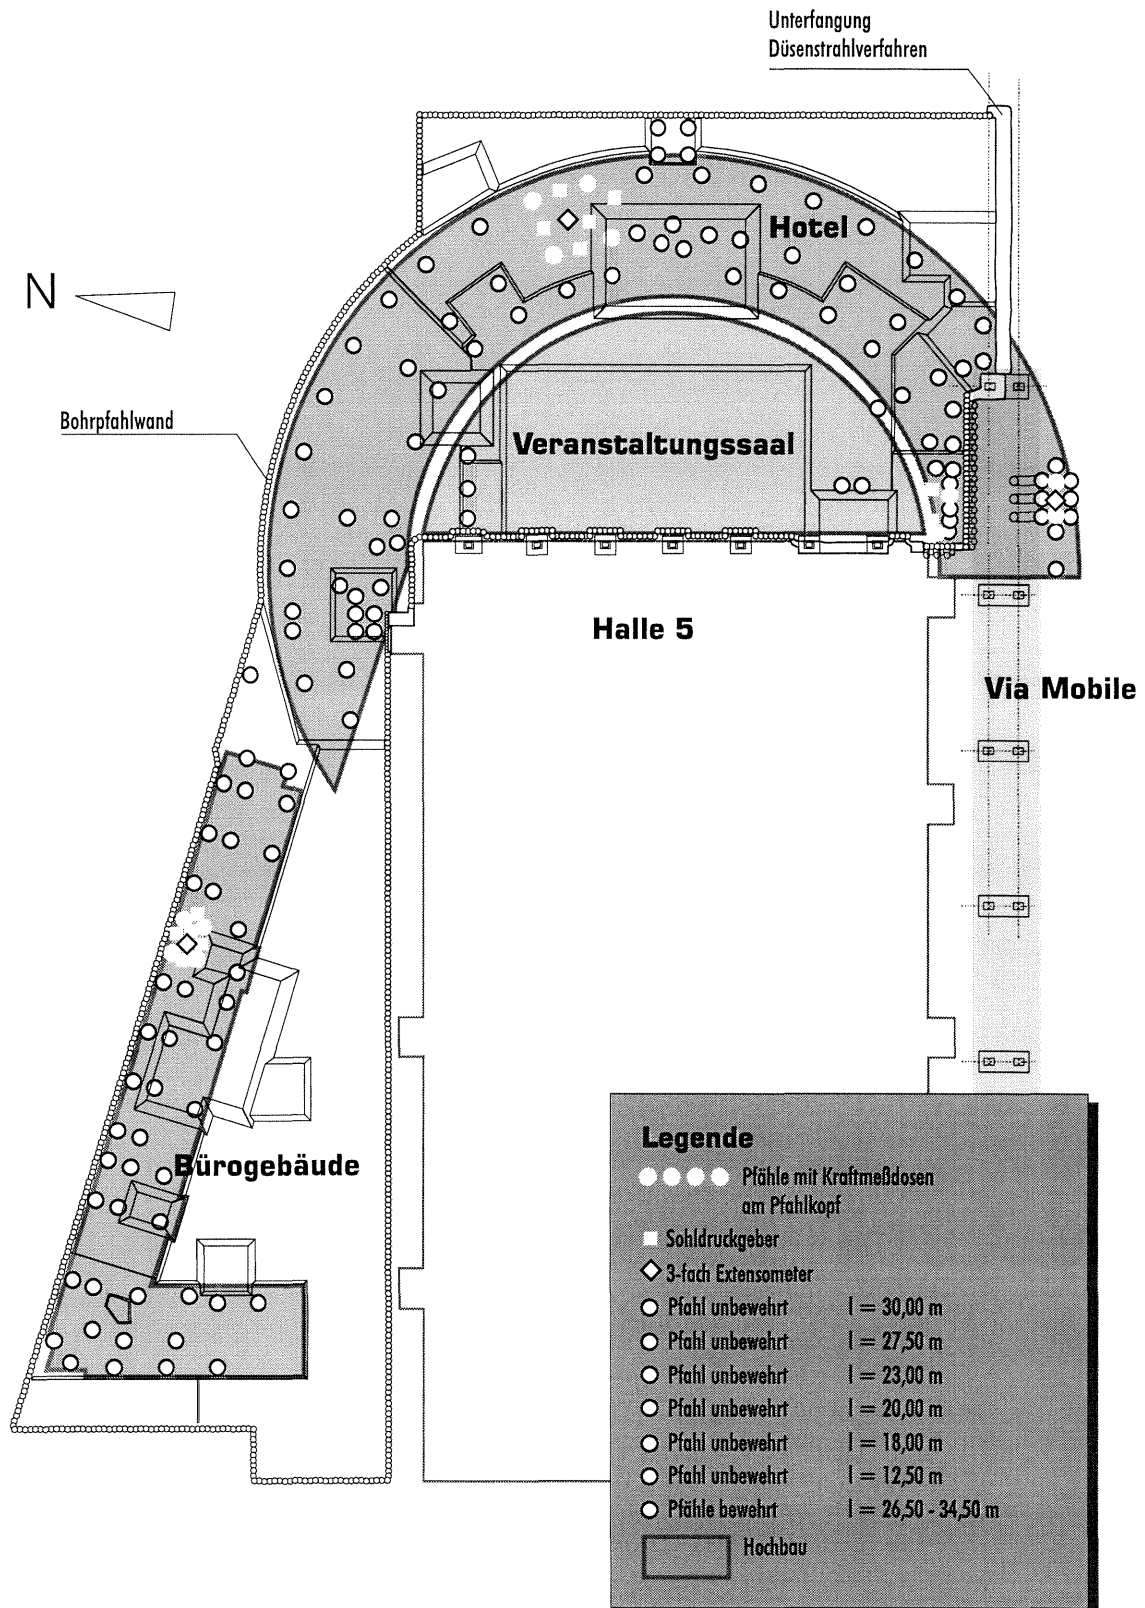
Grundrißplan mit Gründungspfählen und geotechnischen Meßeinrichtungen
